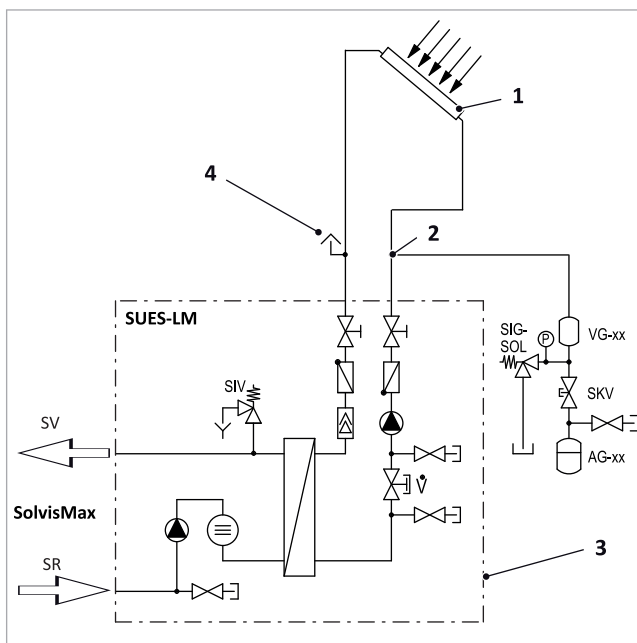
Hydraulikschema Einbindung Luftabscheider
